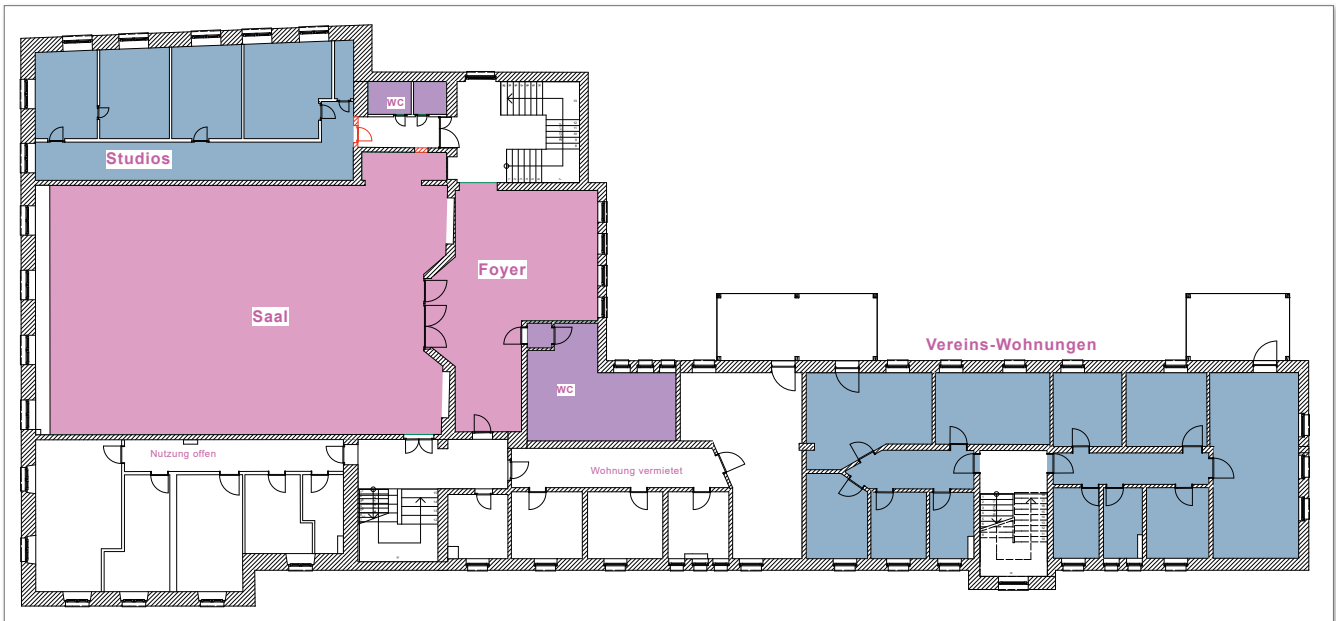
Grundriss 1. Obergeschoss - Nutzungskonzept Altes Lehngericht (M14), Darstellung Esther Gerstenberg
